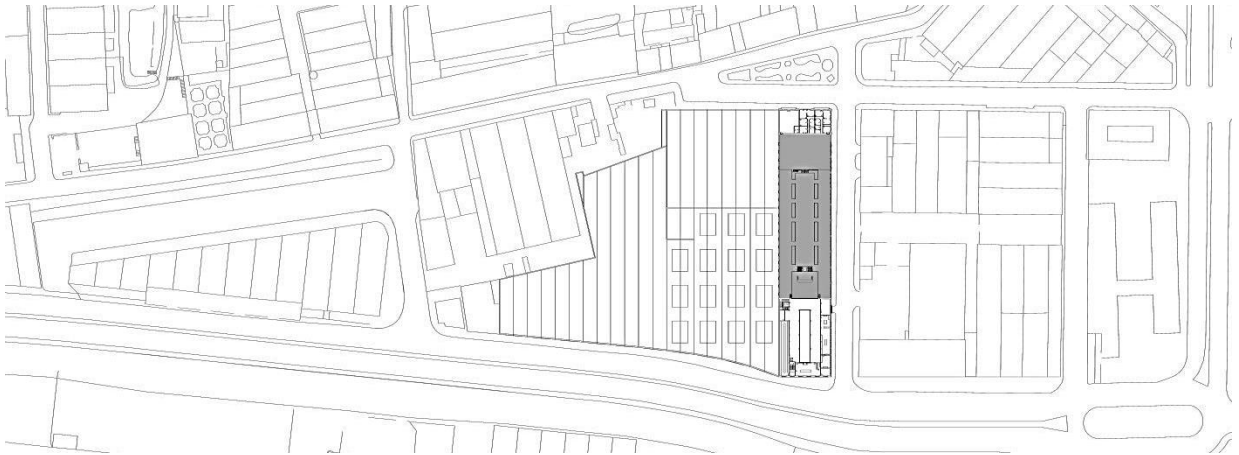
Planta de levantamento fotográfico piso 1 – Armazém 2.
